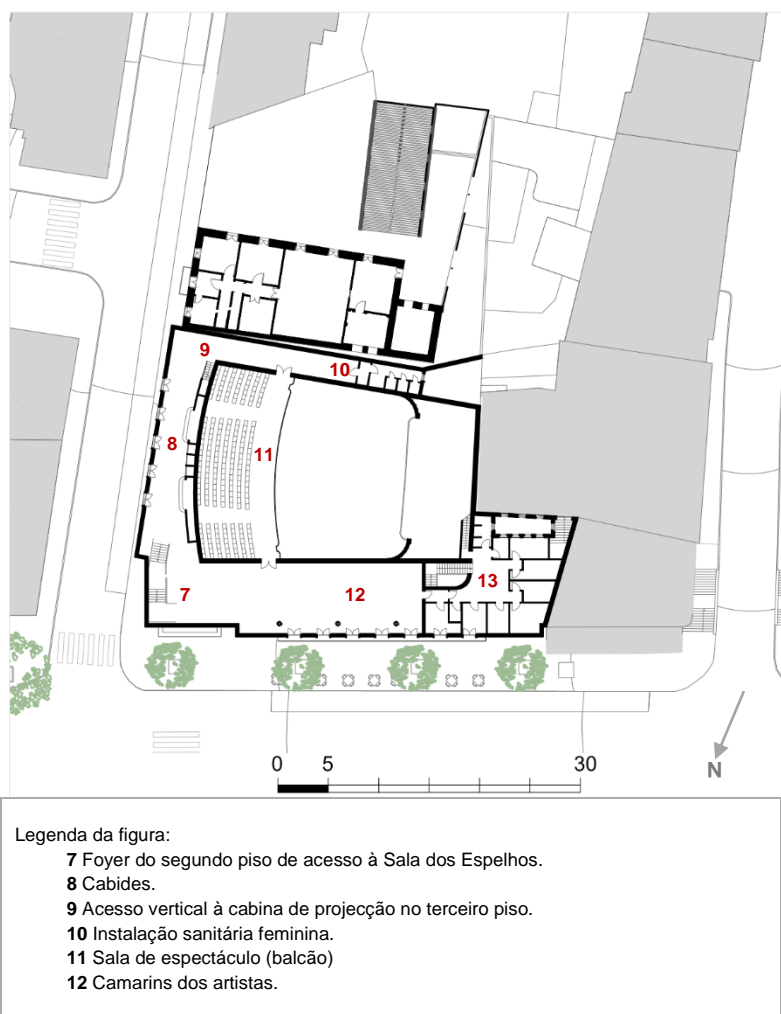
Planta do primeiro piso do Cine-teatro Gardunha e localização das funções.
